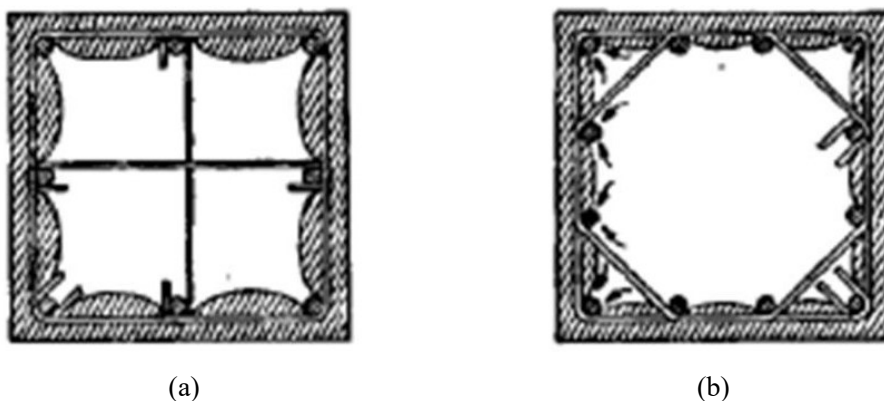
Concreto efetivamente confinado por estribos retangulares.
